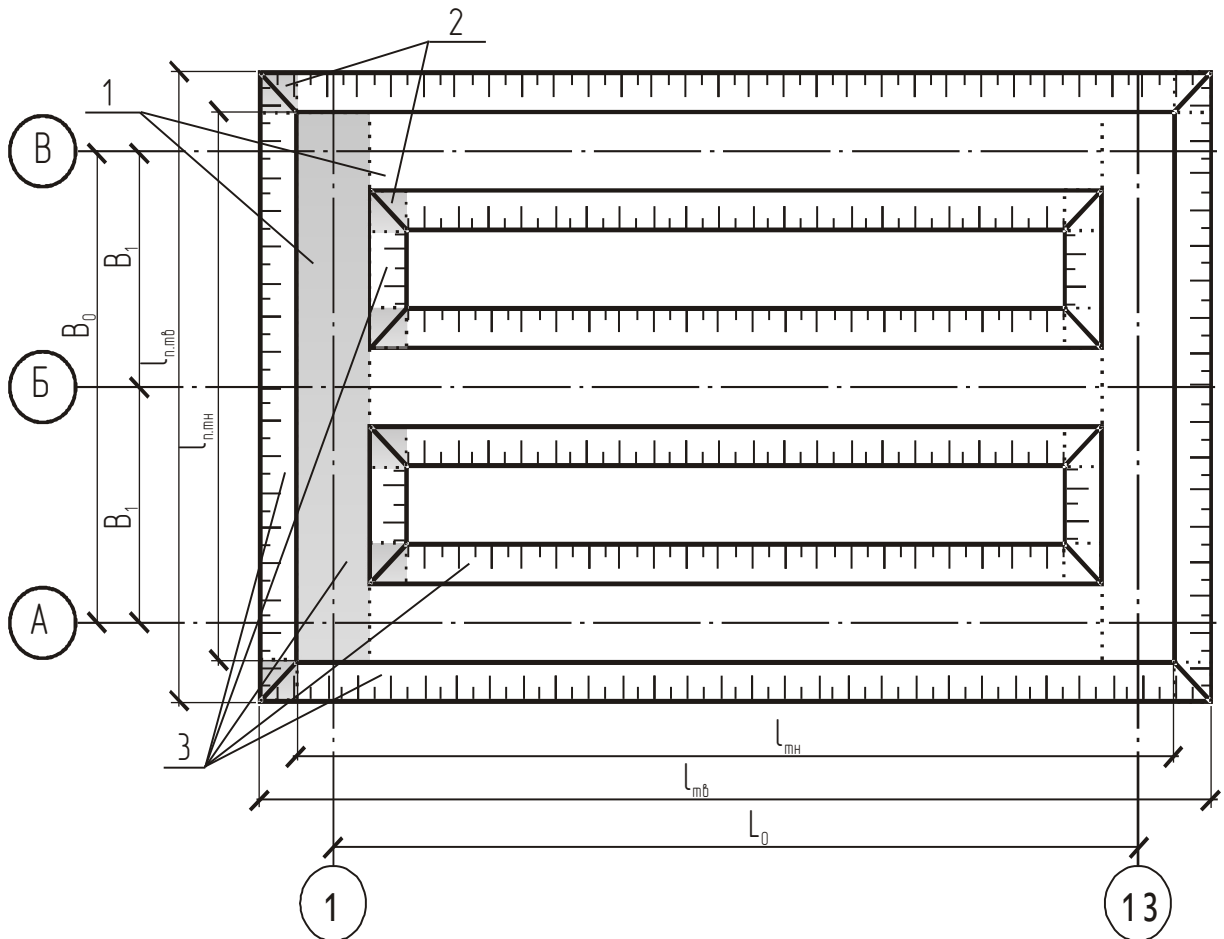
Схема під будівлю з стрічковим фундаментом
